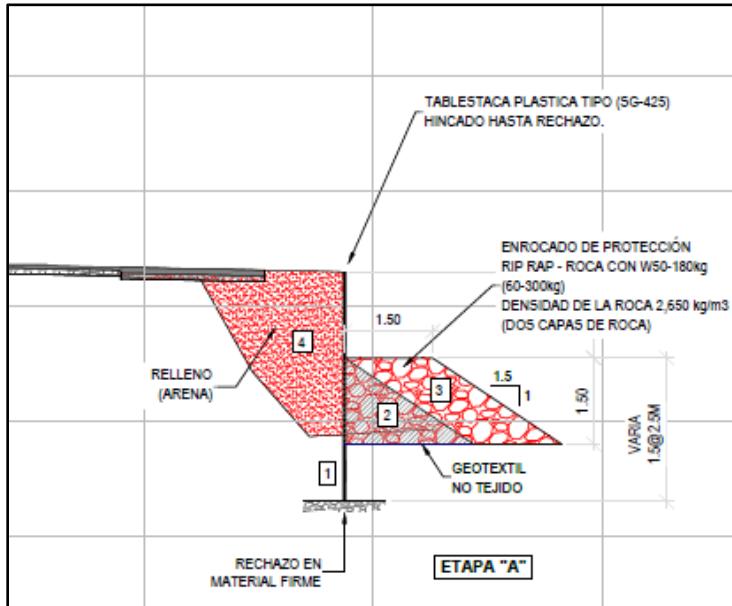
Detalle de construcción de tablestacado y enrocado.
